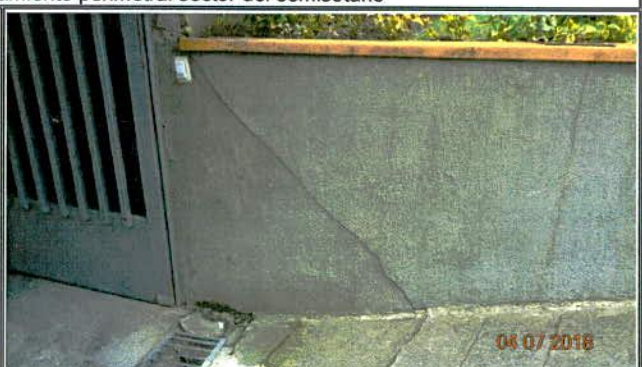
Grieta en muros de acceso al semisótano – 04/07/2018
